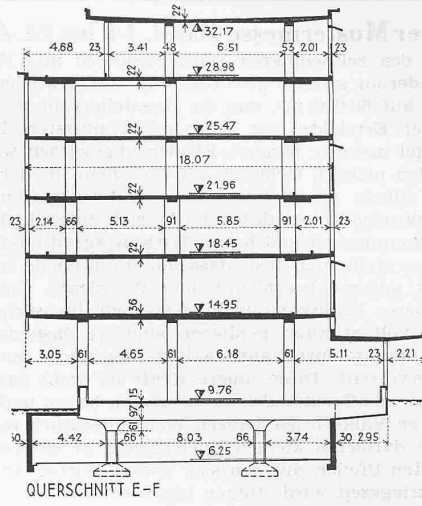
Schnitt der Eisenbetonkonstruktion, Masstab 1 : 400 — Ing. R. MAILLART †
